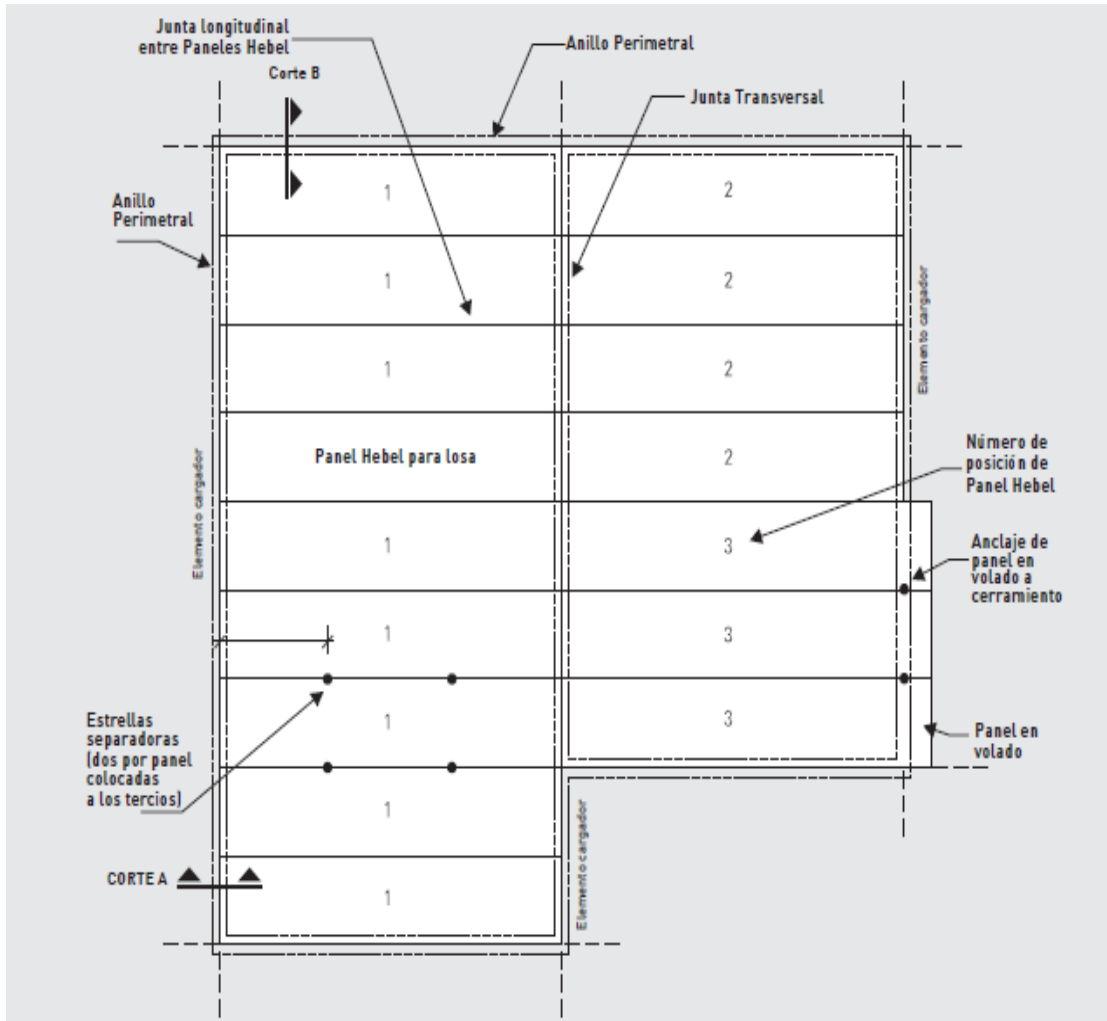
Detalle final en planta de la colocación del panel losa sobre el enrase de muros.
